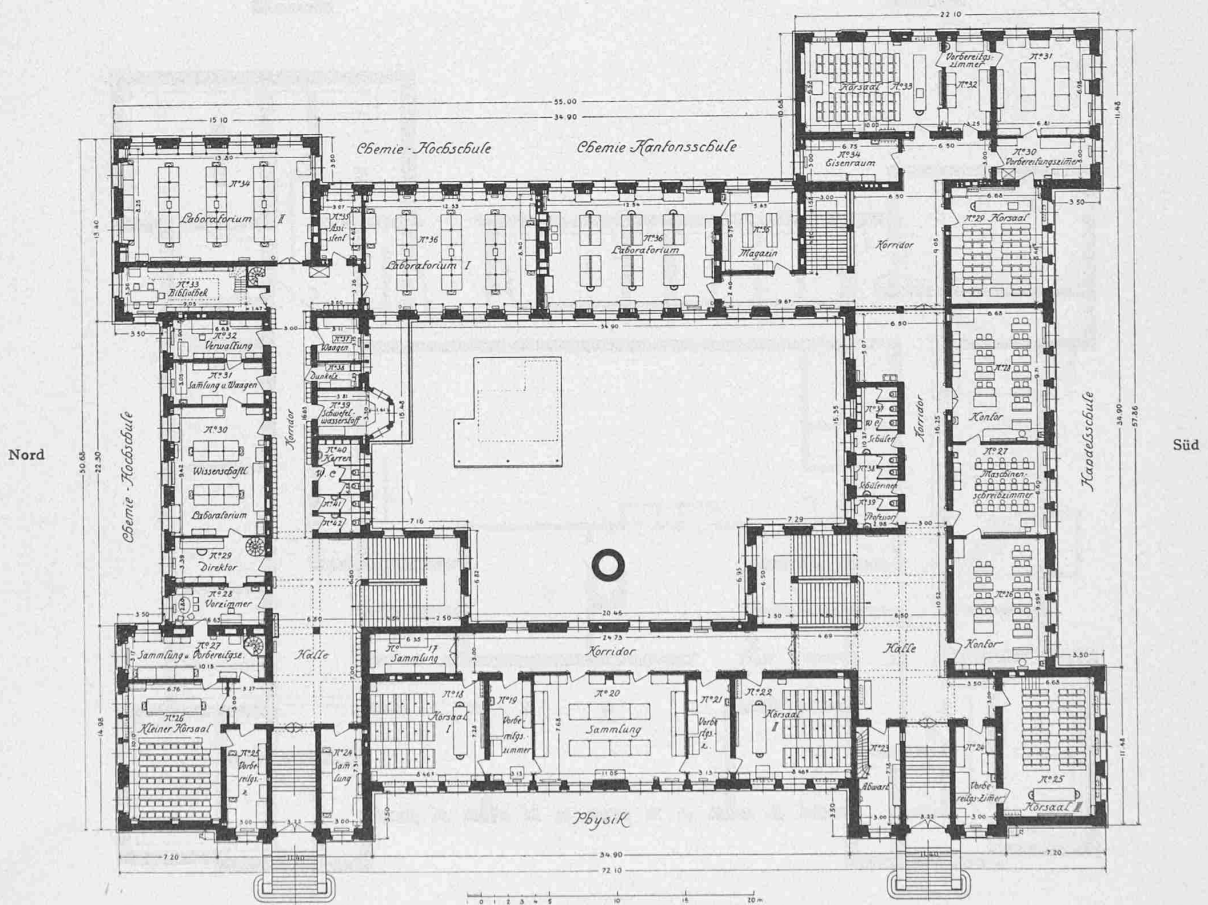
Grundriss vom Erdgeschoss (Hochparterre). — Masstab 1 : 500.
